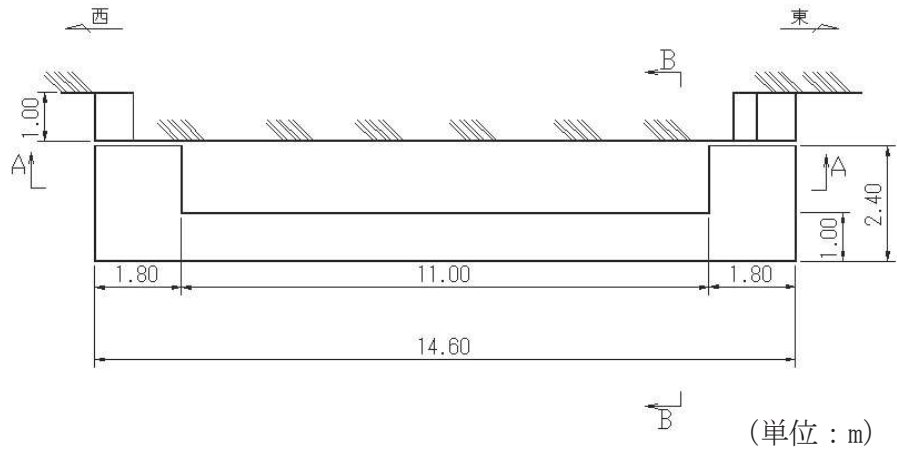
第 3 号機補機冷却海水系放水ピット平面図 (C-C 断面)
